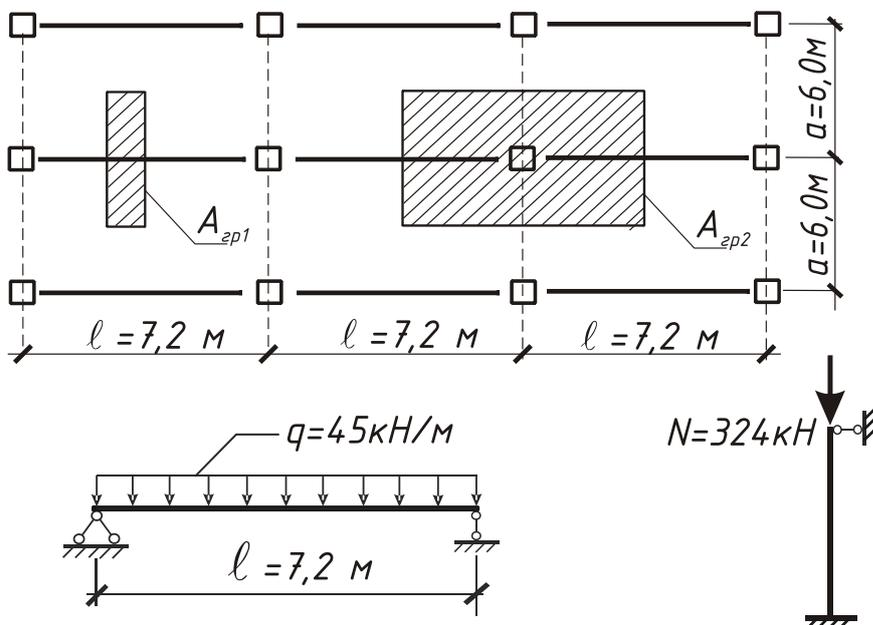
Грузовая площадь и расчетная схема балки и колонны
